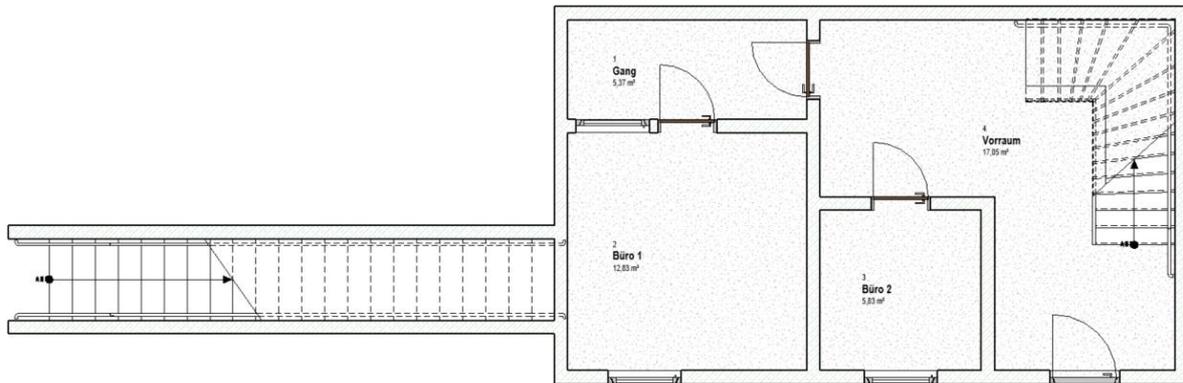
Grundriss EG BIM-Modell OIB RL 4 – 2.4.2
